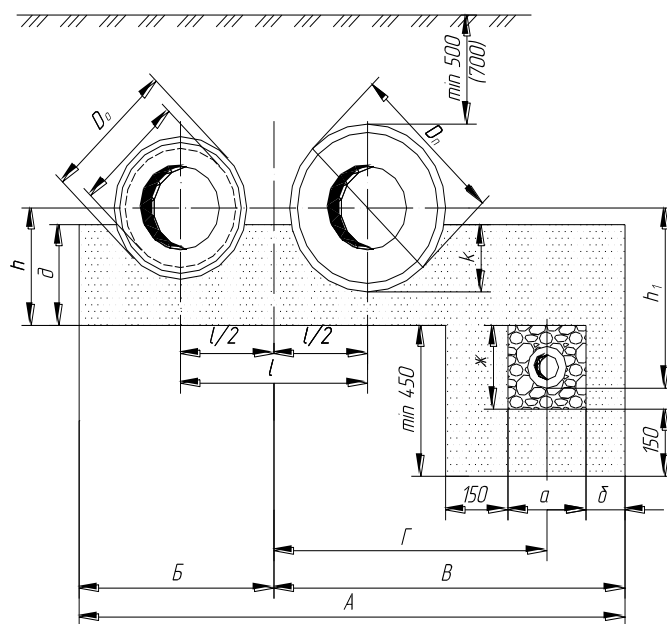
Приклад безканального прокладання тепломереж в армопінбетонній ізоляції в мокрих ґрунтах (з дренажем)
